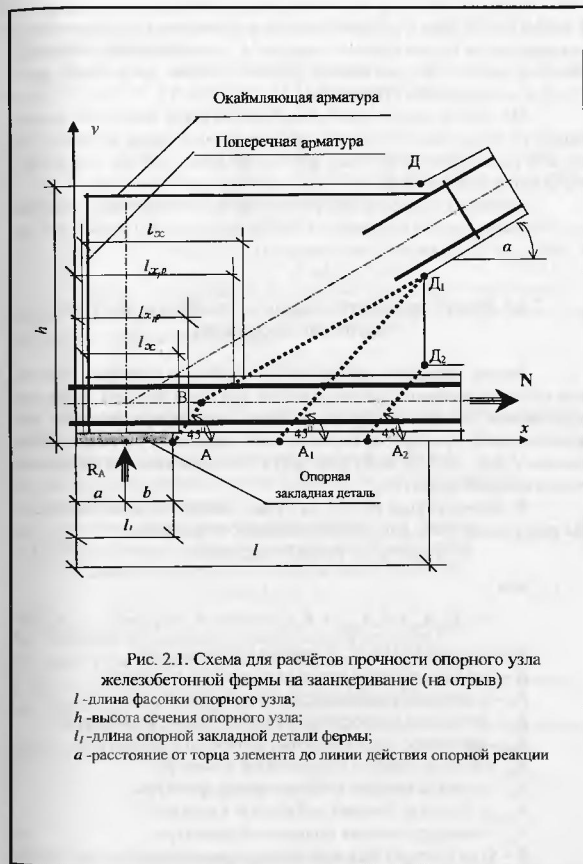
Схема для расчётов прочности опорного узла железобетонной фермы на заанкеривание (на отрыв)
